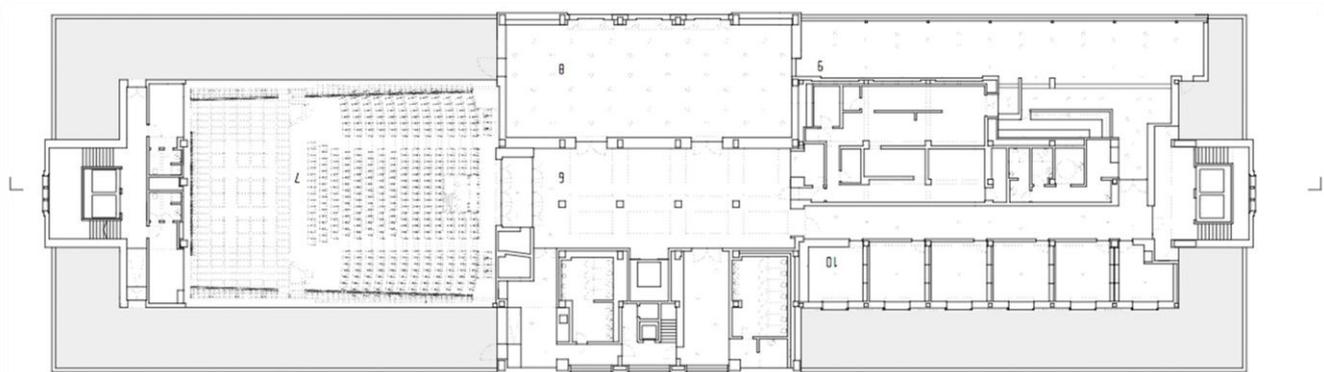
Planta piso 5, 1:500, Museu do Oriente. JLCG Arquitectos
